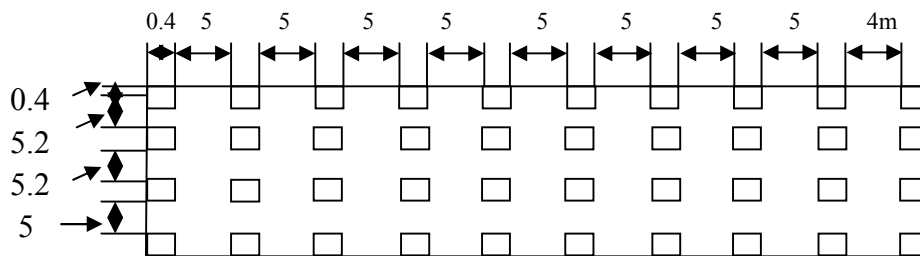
Vu en plan du bâtiment de la station de pompage.
